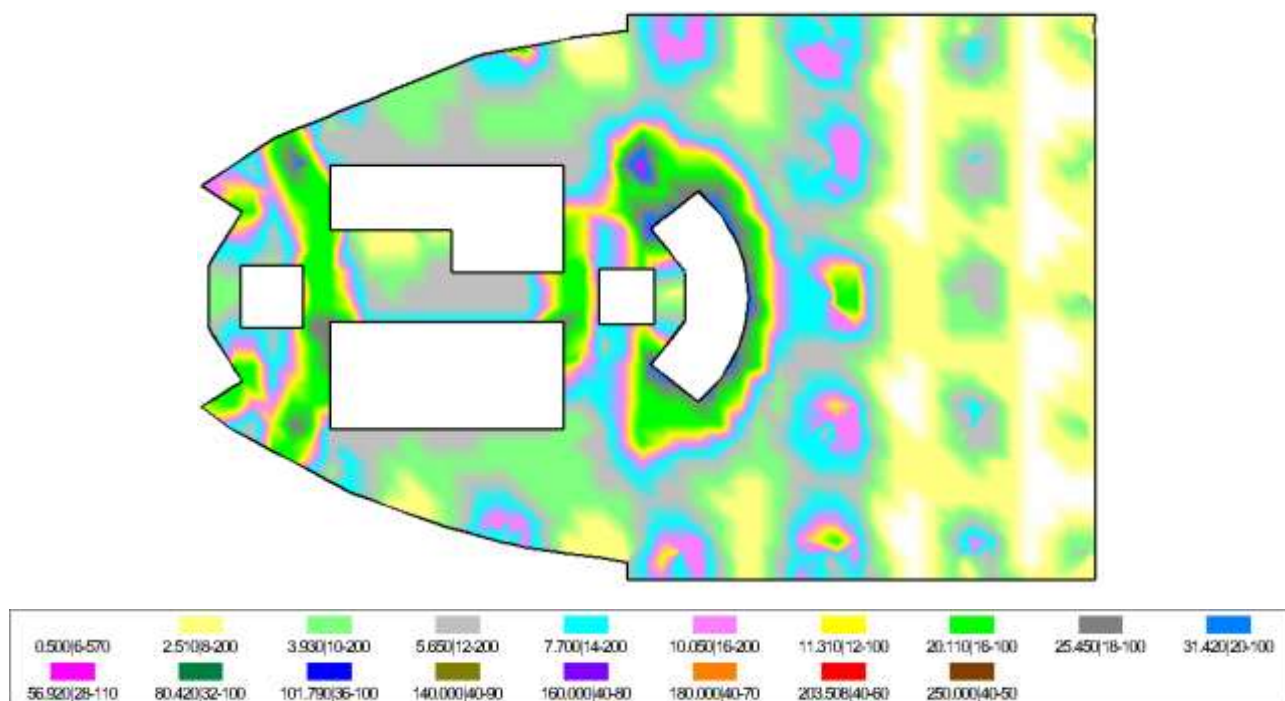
Армирование плиты перекрытия восточной башни на отм. +42,80 м. Верхняя продольная арматура в направлении оси R, см²/м [15]
